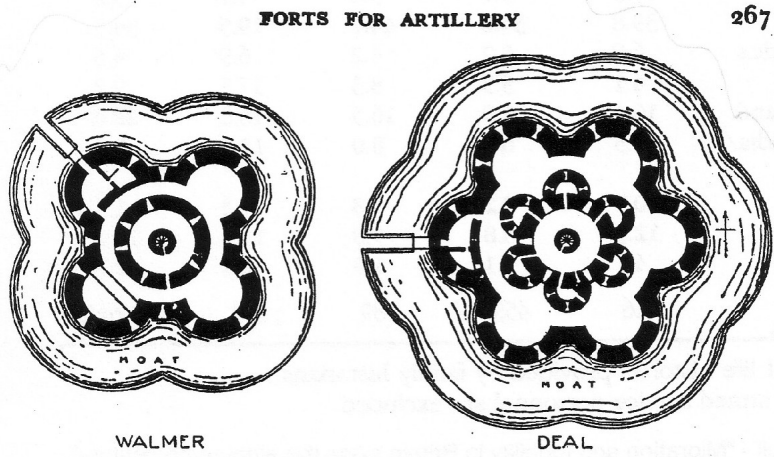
Festungen Heinrichs VIII, Grundriss von Walmer- und Deal Castle
